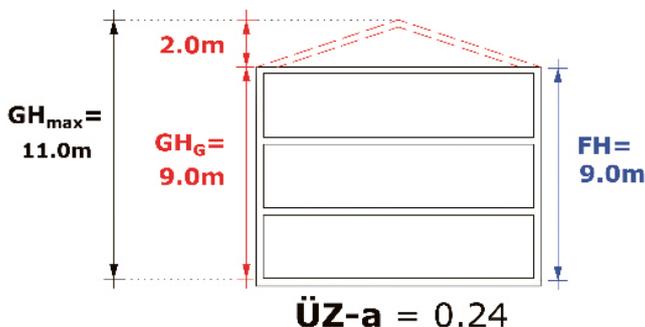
Beispiel Gesamt- und Fassadenhöhe
